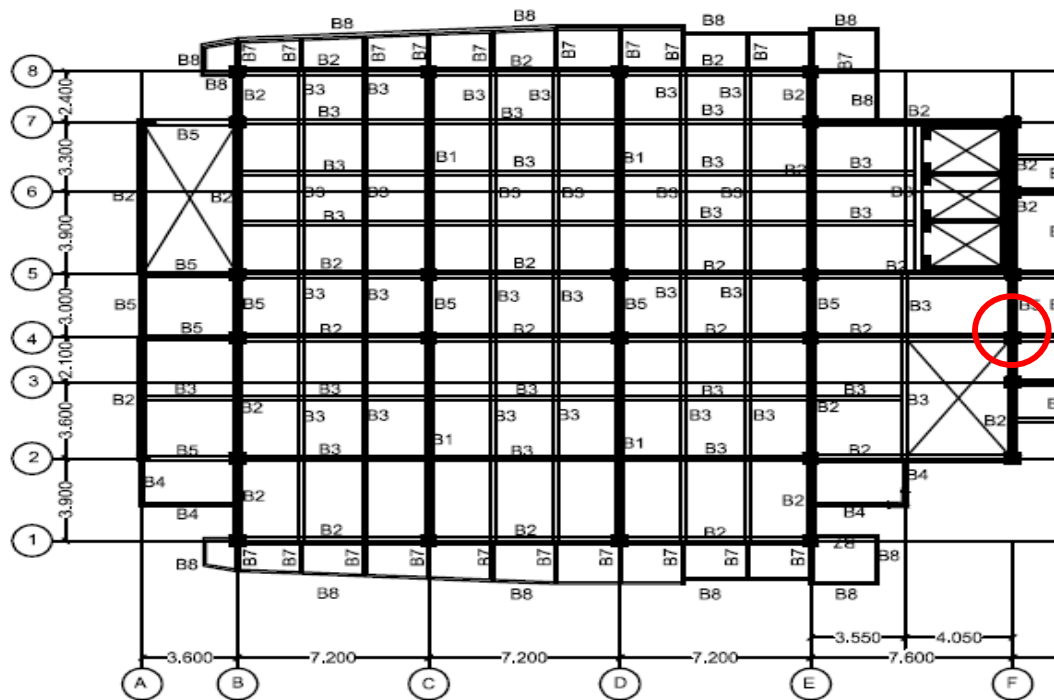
Denah Lantai Dasar Zona 1
